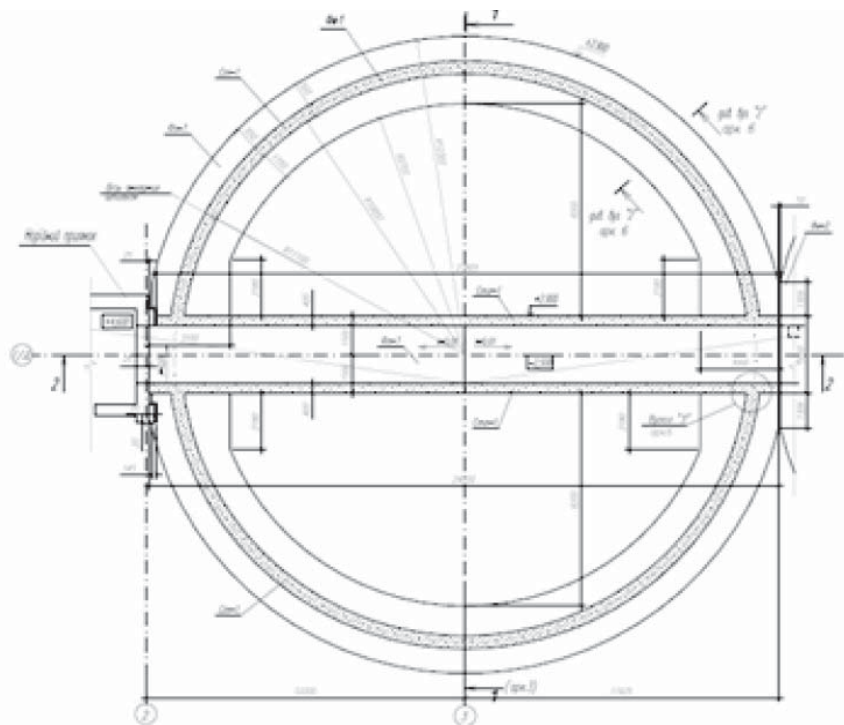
План кільцевого фундаменту силосу СМБУ 220.
